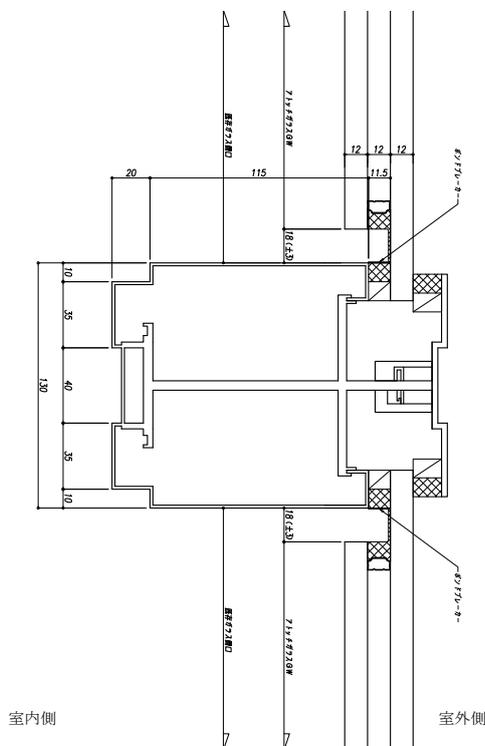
建物 B ガラス追加平面施工図 (縮尺: 1/4)
